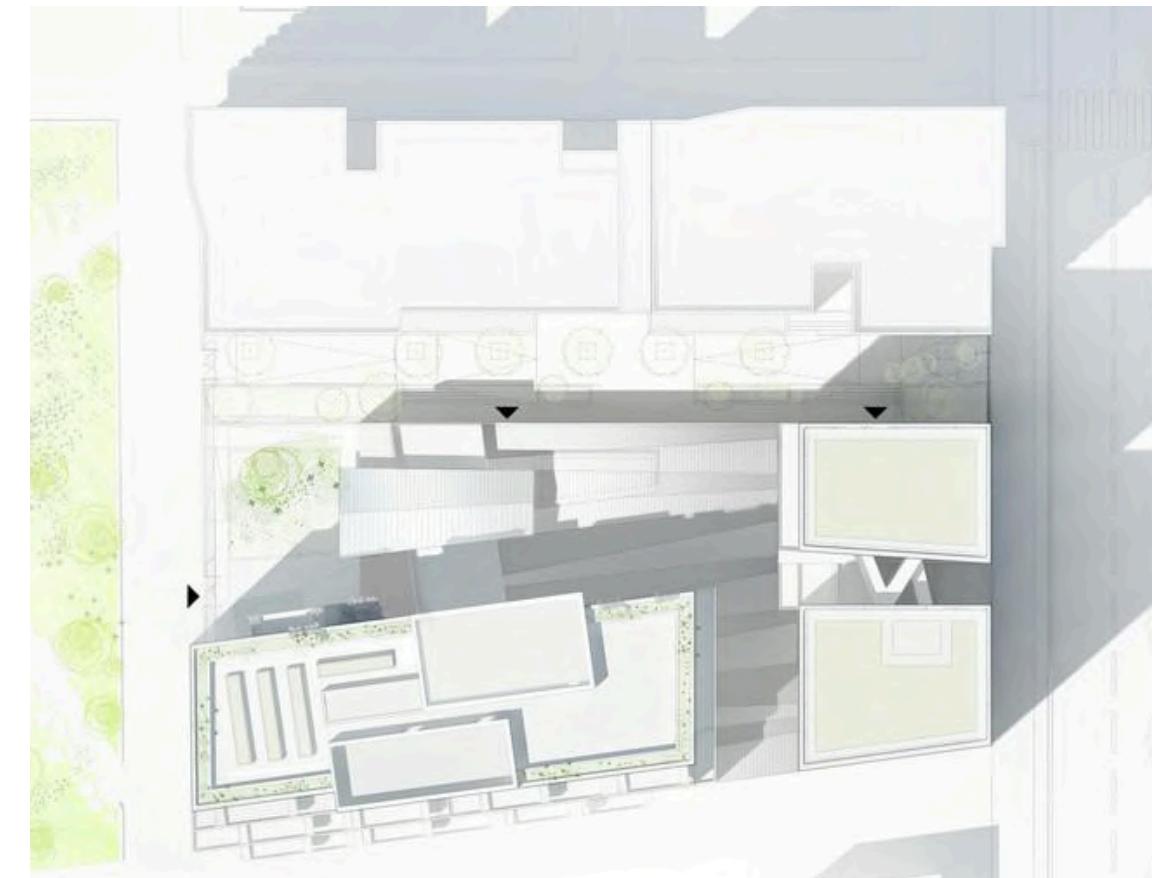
Fachada ativa ao longo da extensão da rua e calçada
